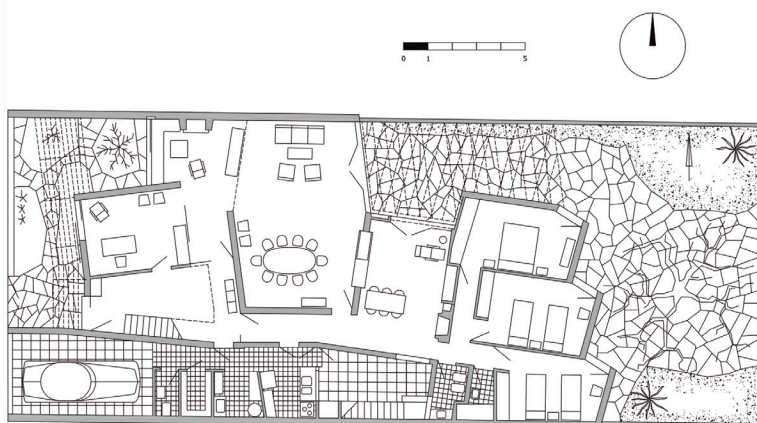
Planta de la casa del Dr. Hidalgo (fuente: Elaboración propia, 2011).
